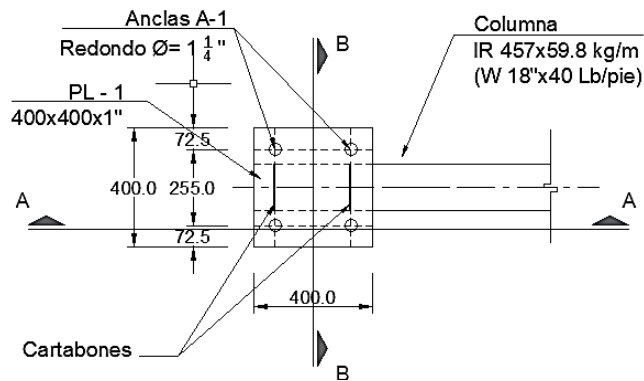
Detalle de los apoyos, vista en planta. Cotas en milímetros
